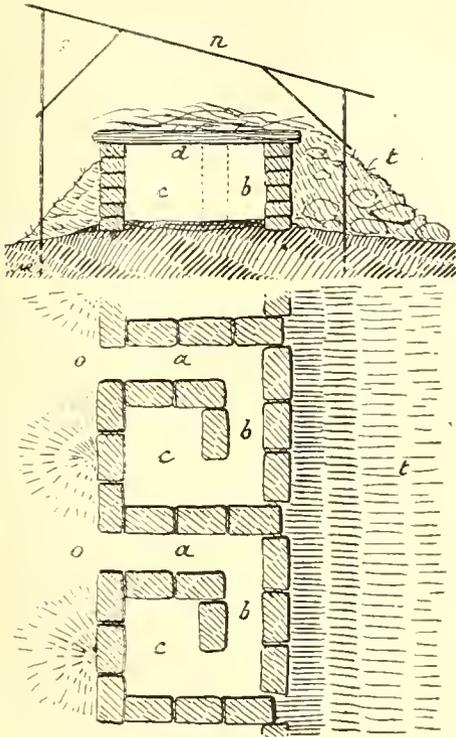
Coupe en élévation et plan d'un terrier construit en briques.
